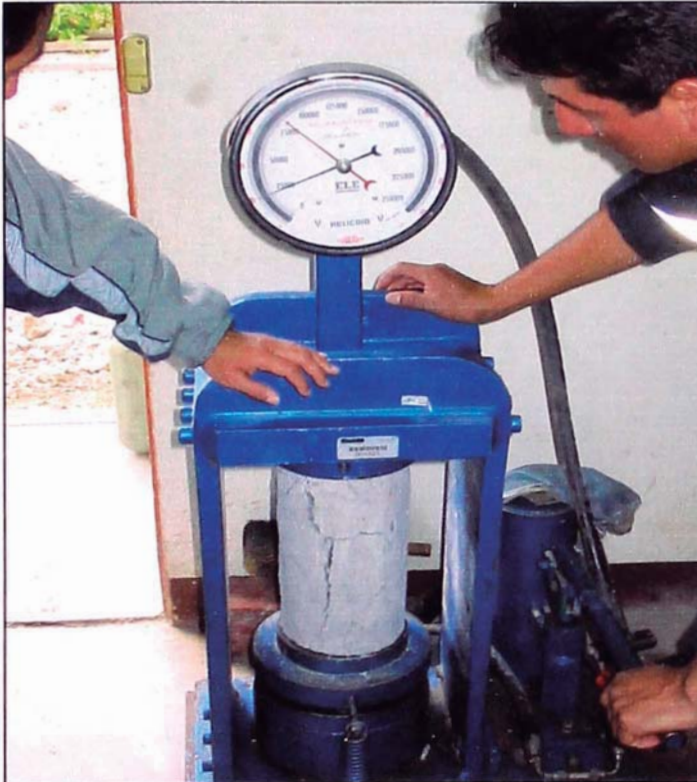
Los ensayos de concreto se realizaban en el laboratorio de concreto que se tenía en Matibamba, en la vista se puede apreciar la prensa que se utilizaba.
